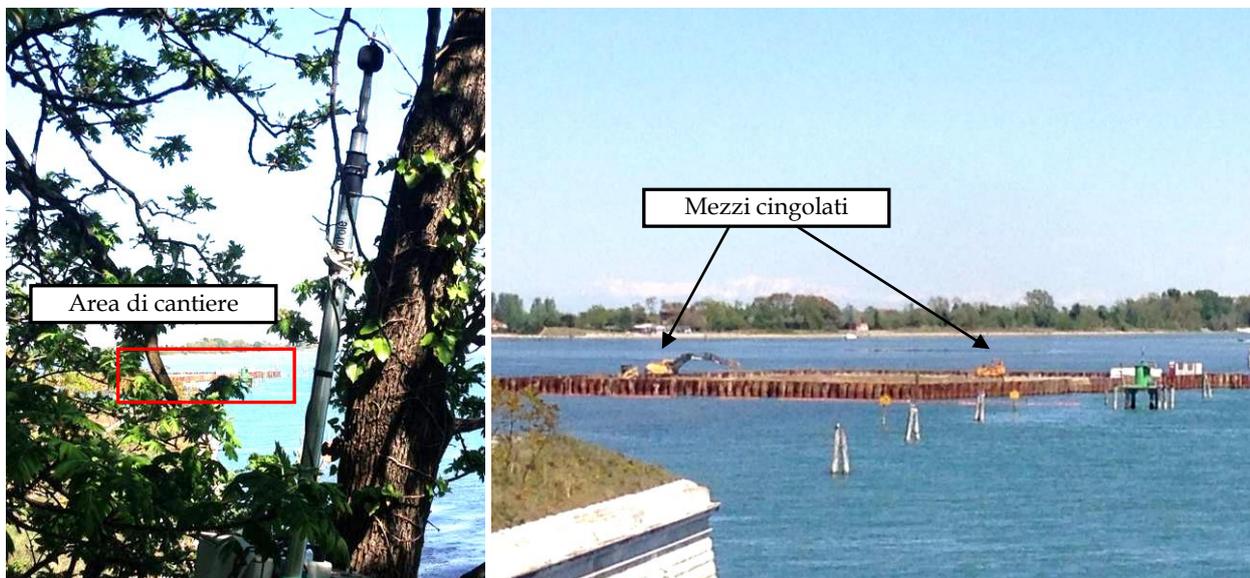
Foto della centralina di monitoraggio con la zona di cantiere sullo sfondo (a sinistra); foto dell'isola provvisoria con macchinari per movimentazione e compattazione sabbia (a destra).
